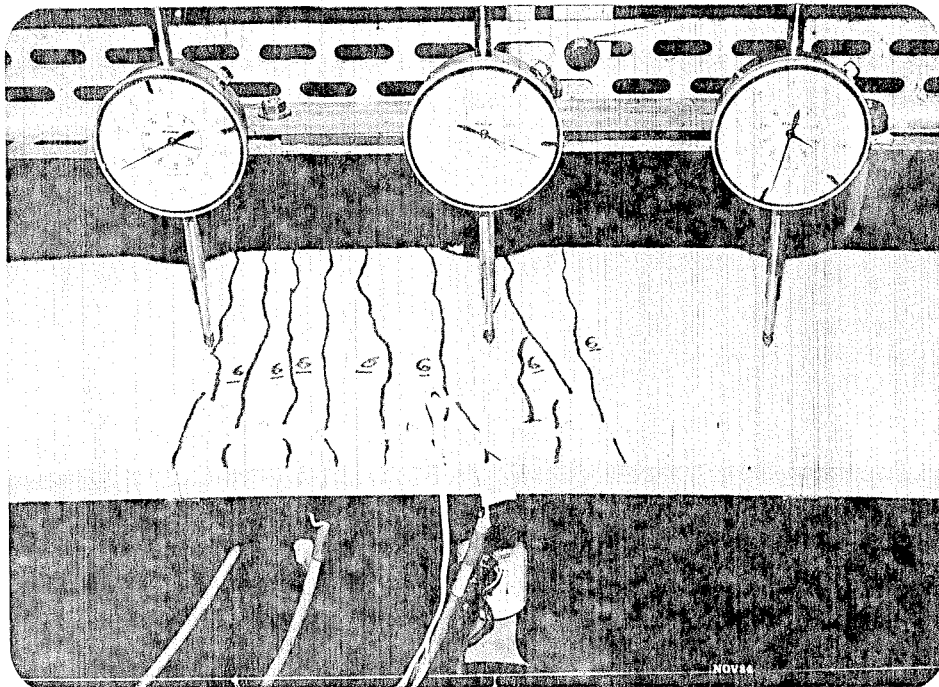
Fissuração em desenvolvimento.
